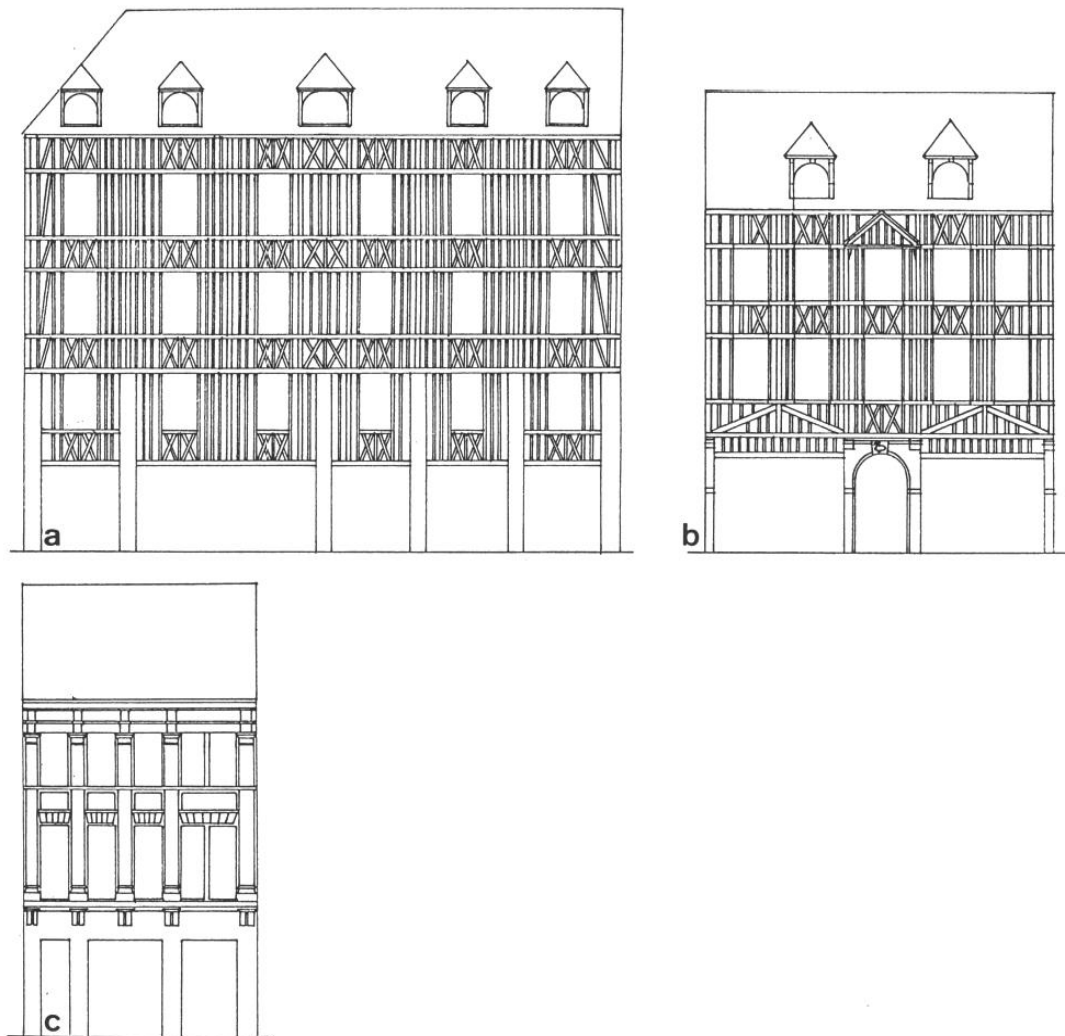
Autres exemples de maisons édifiées entre 1600 et 1649.
